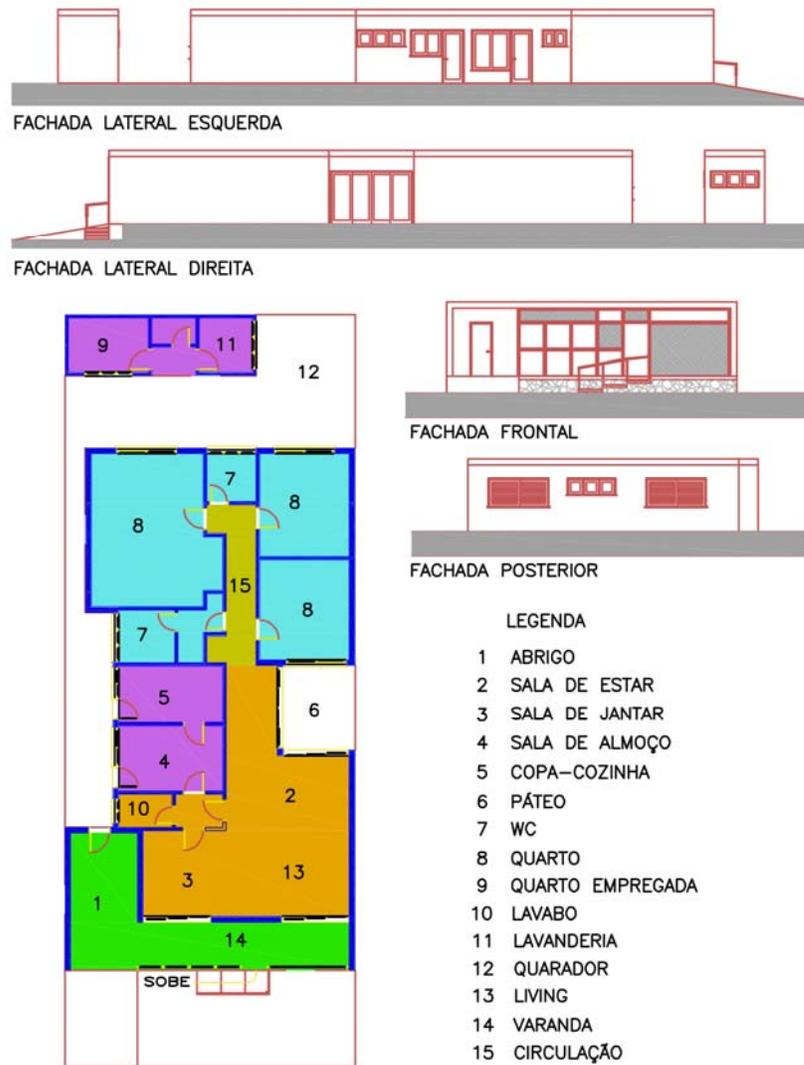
Casa José Baracat, 1963 – Planta baixa e fachadas
